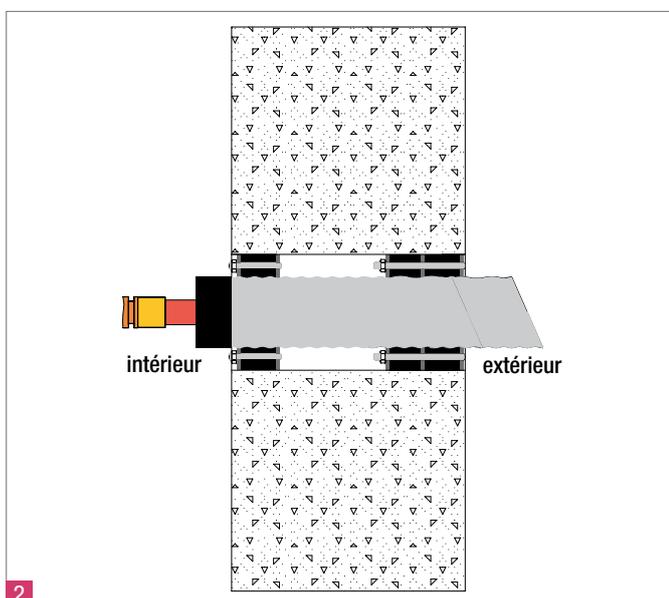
, bride murale étanche FA 80 et FA 40, vue latérale
